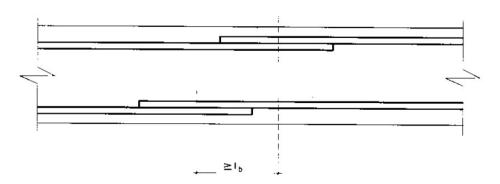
Empalmes de las distintas barras en tracción
